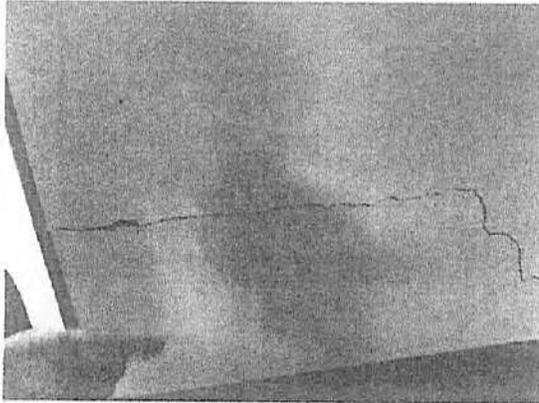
Fisura horizontal de muro con carga baja
